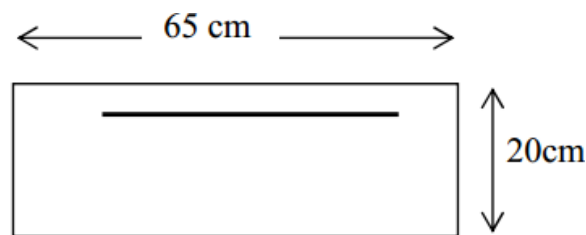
Coupe schématique de la poutrelle (travées)
